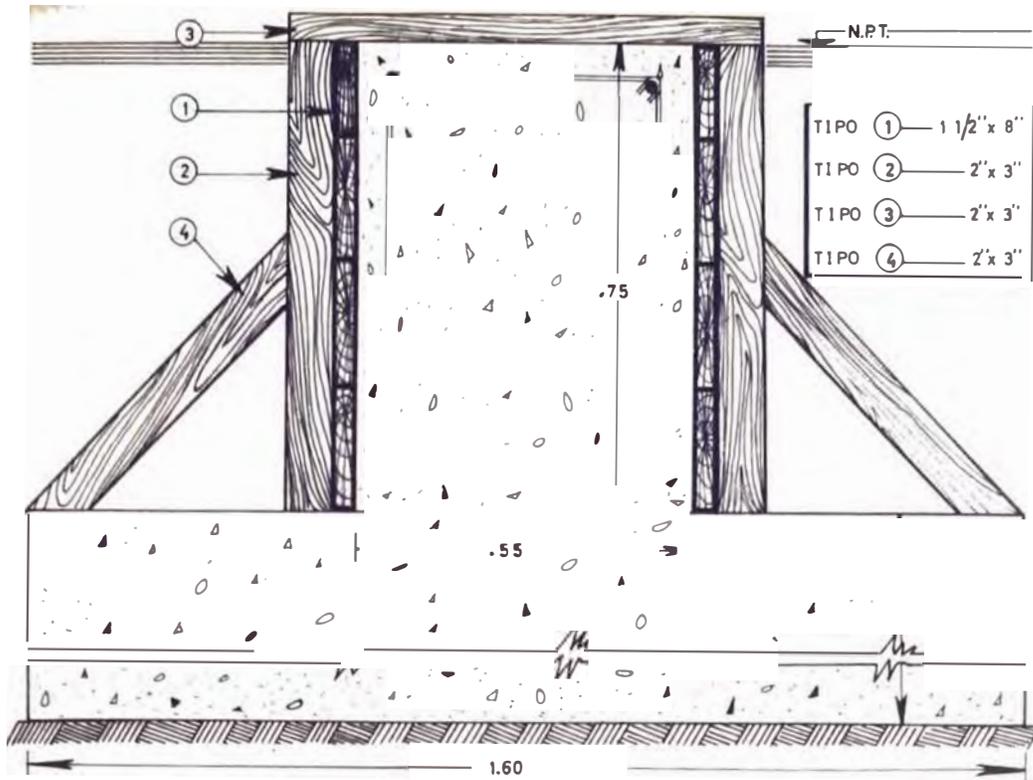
ENCOFRADO DE VIGA DE CIMENTACION — EJE S H-I
